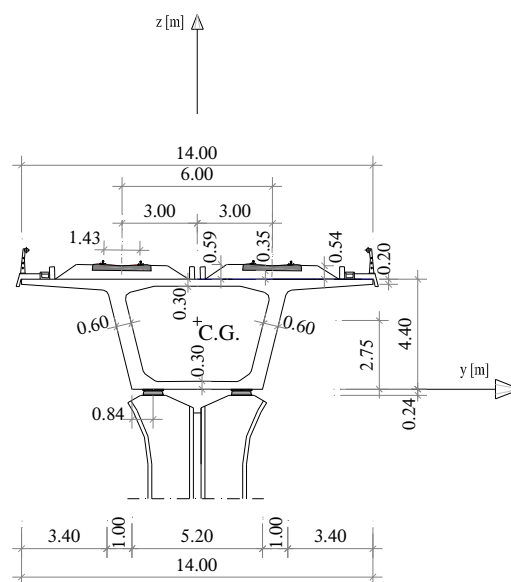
Secção transversal tipo do tabuleiro (adaptado de Parra, 2005)
